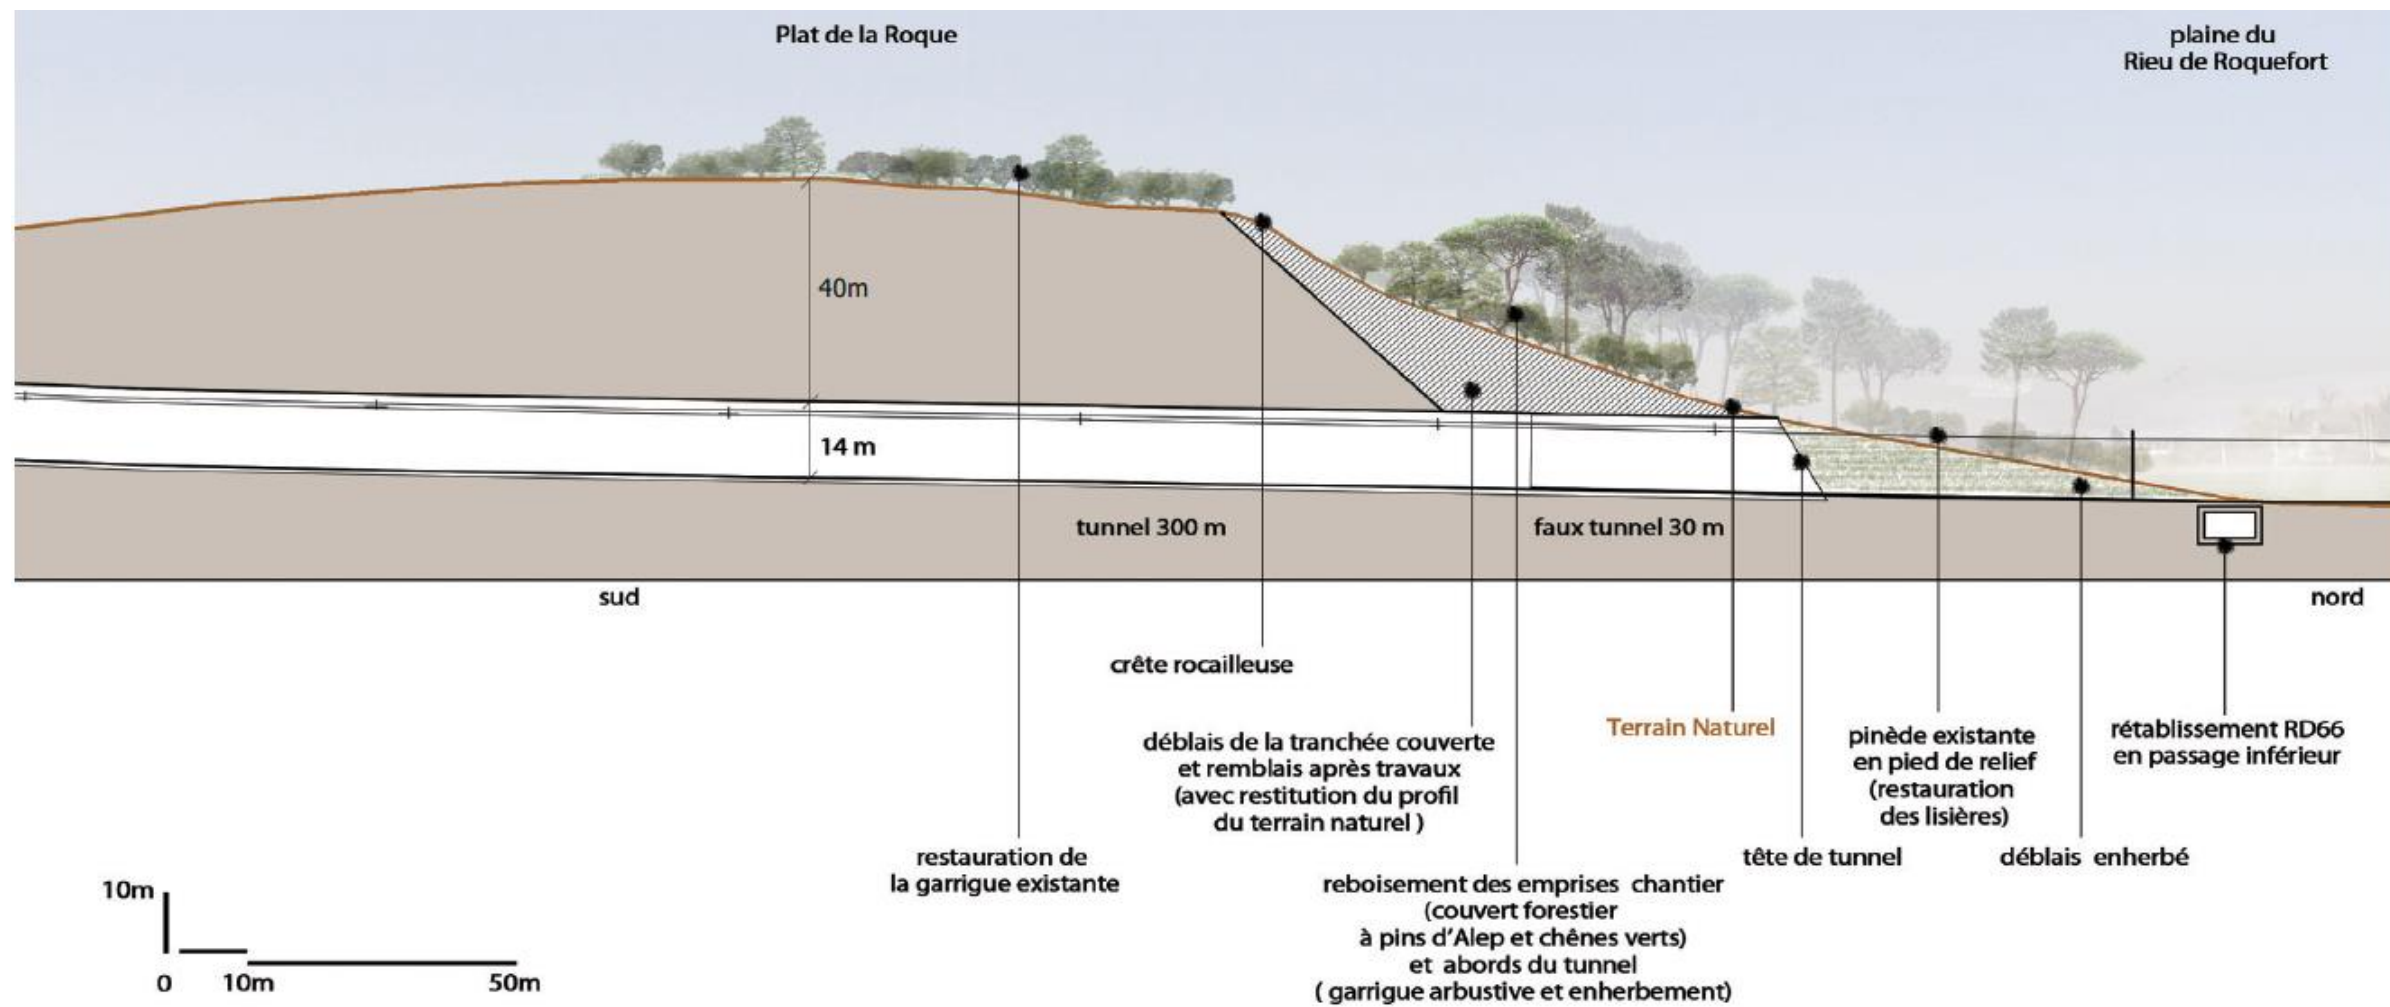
profil en long du tunnel de Roquefort-des-Corbières (source : Ingerop et Traverses)
